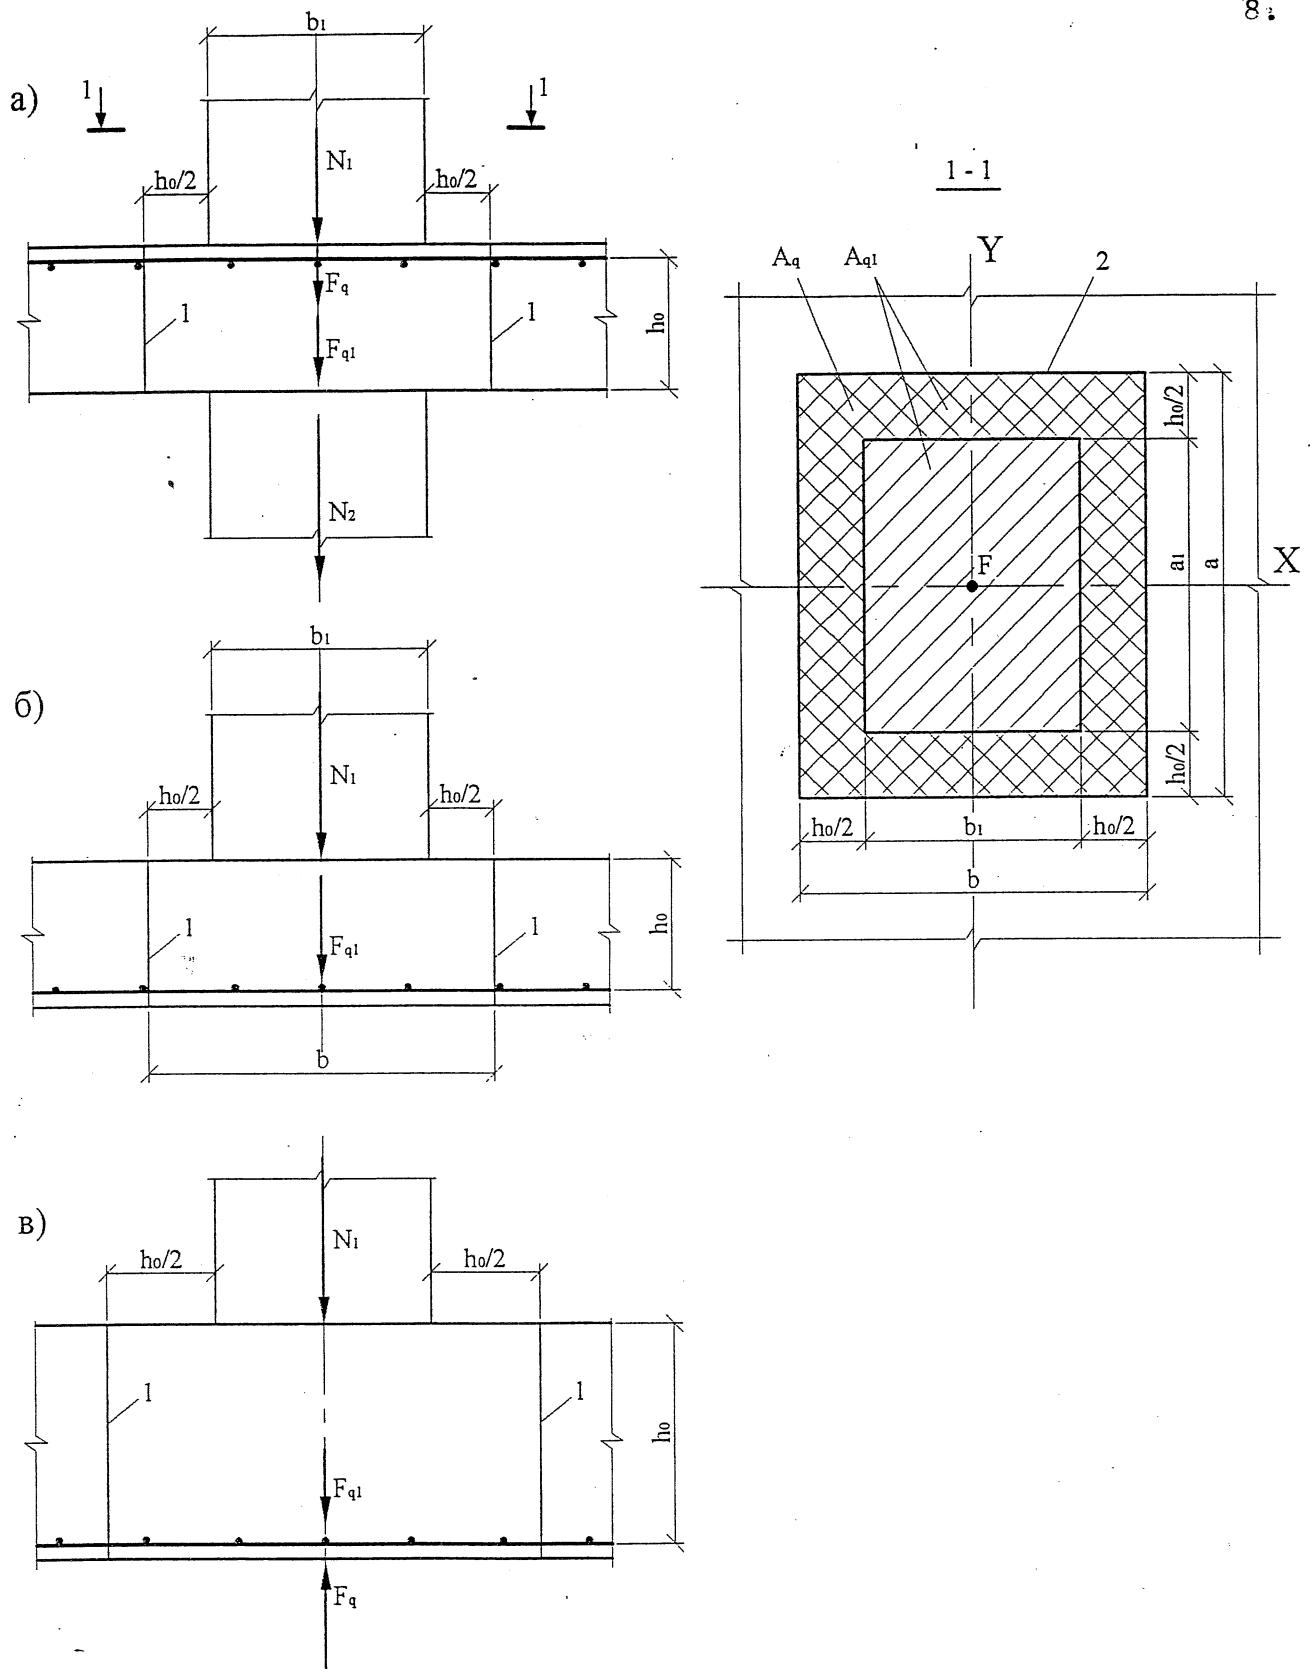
Схемы для расчета железобетонных плит без поперечной арматуры на продавливание
